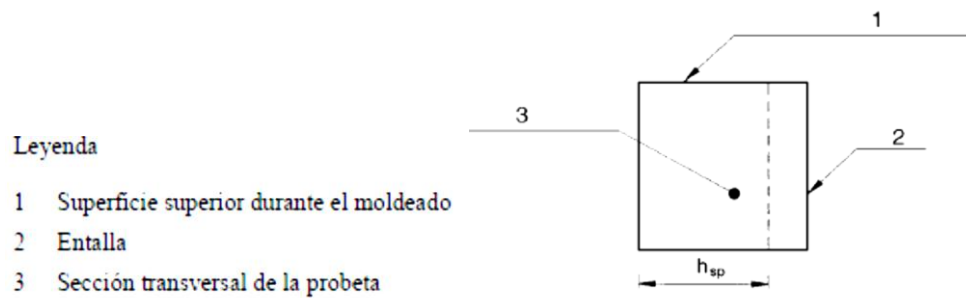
Posición de la entalla serrada en la probeta antes de la rotación.
